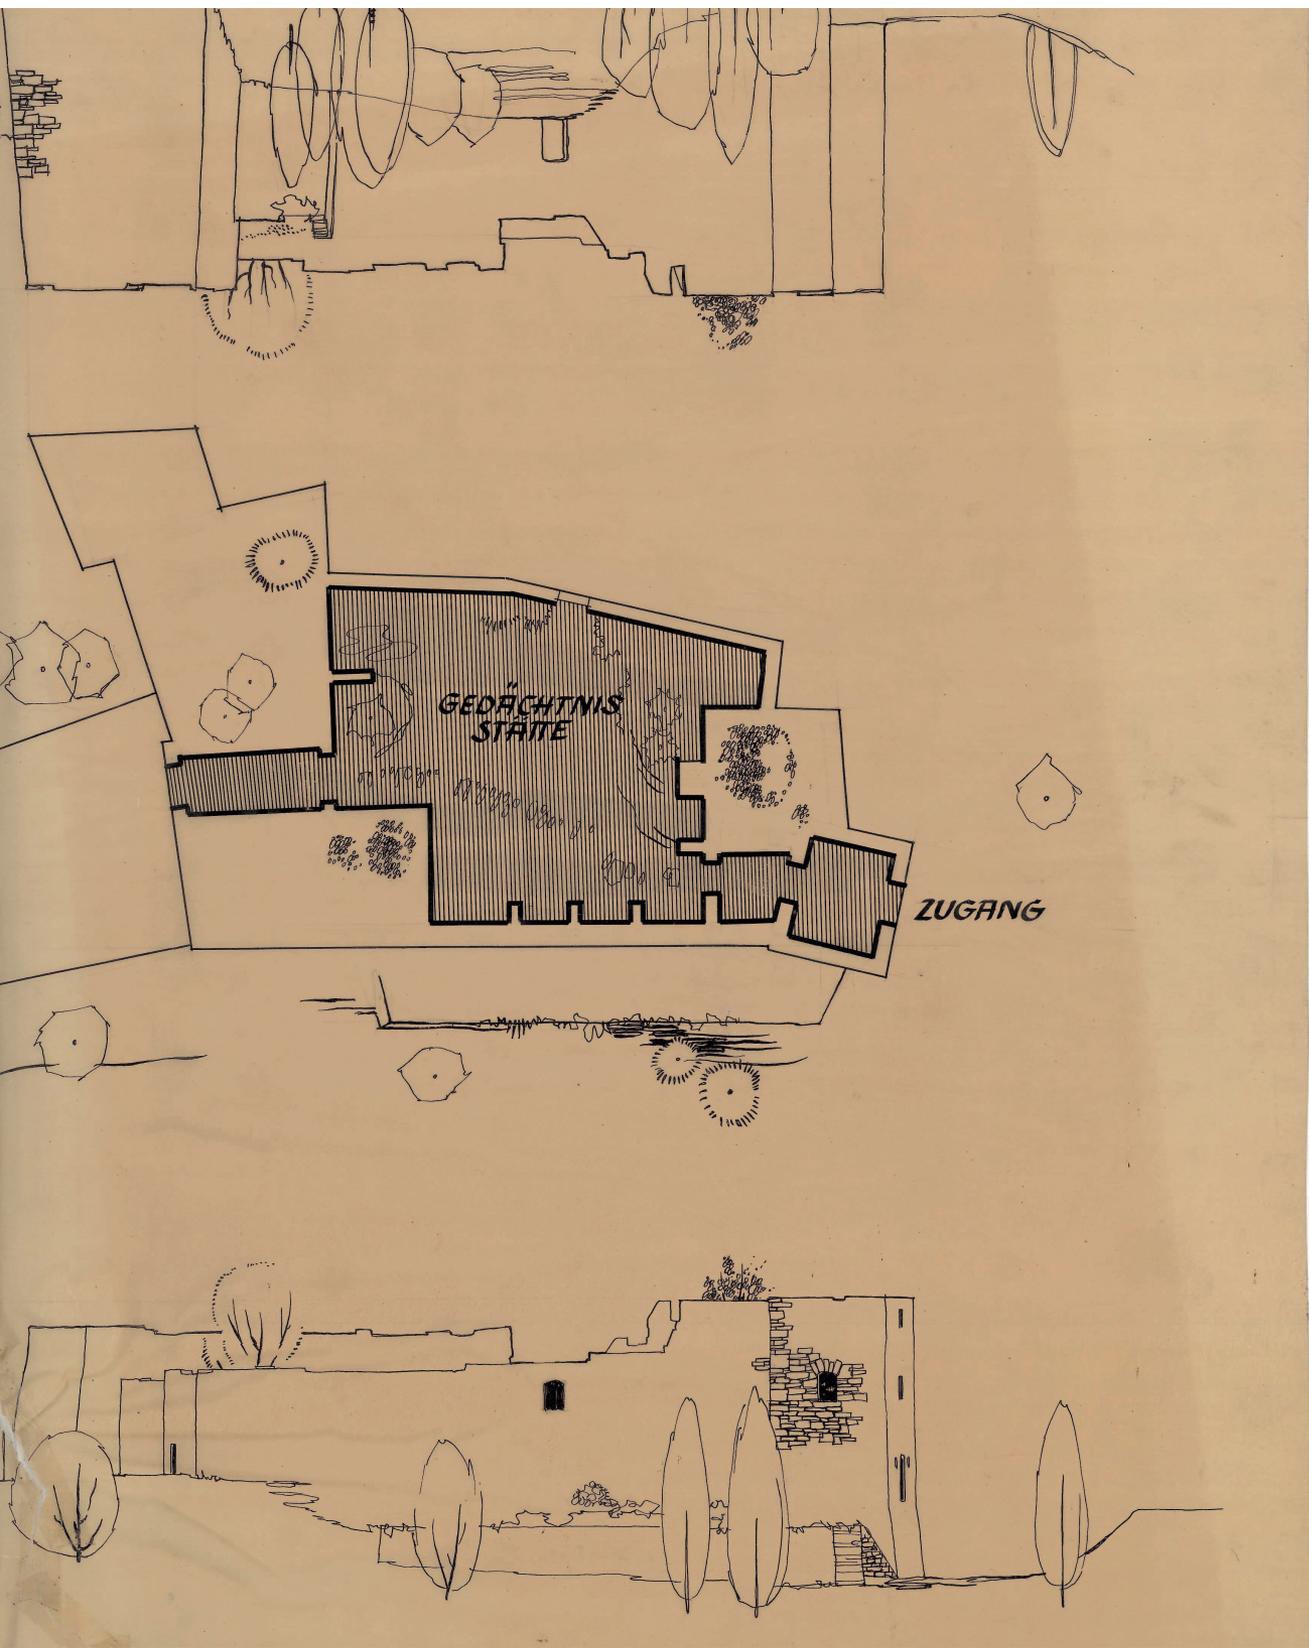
| Grundriss und Ansichten der Burg Oberkapfenberg
